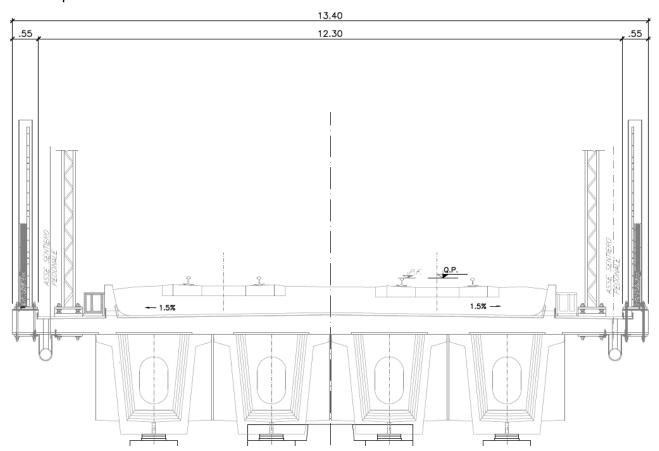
Sezione tipo - trasversale impalcato con travi c.a.p.
